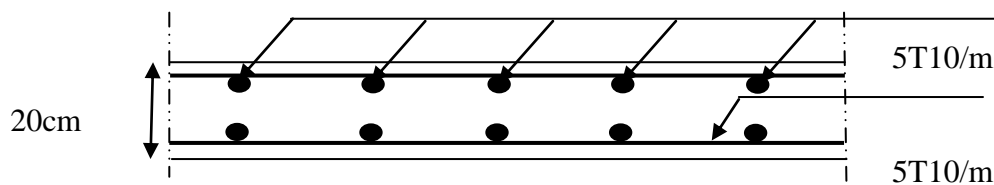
Coupe horizontale du ferrailage du voile périphérique
